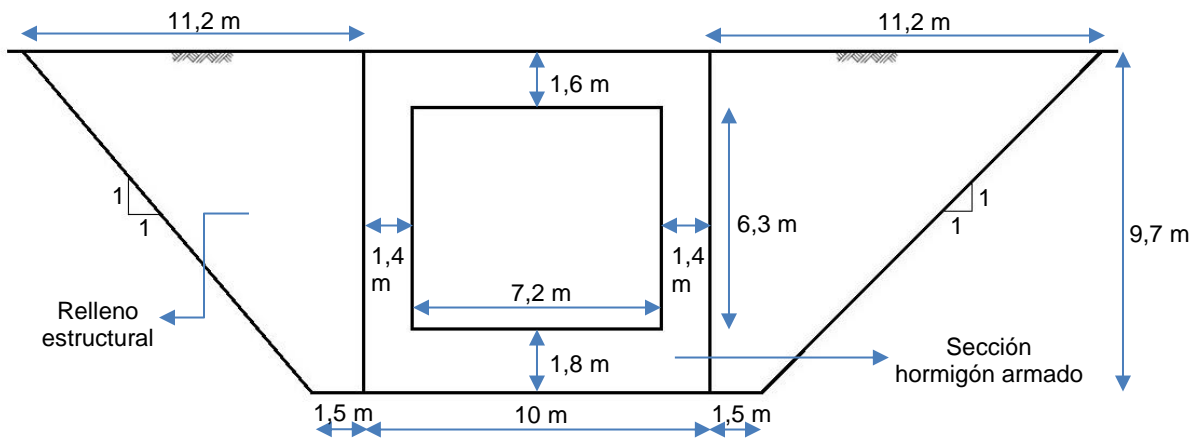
Sección transversal túnel de hormigón armado para el cálculo de costos. Fuente: Elaboración propia
